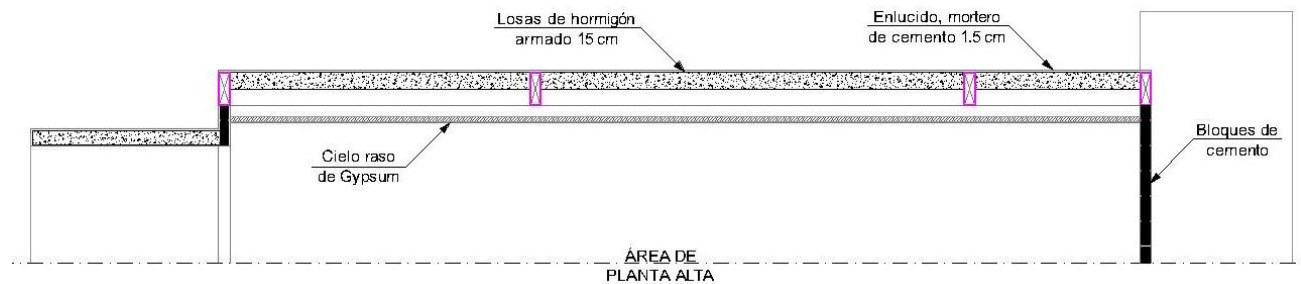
Cubierta plana del proyecto base. Elaboración Propia
